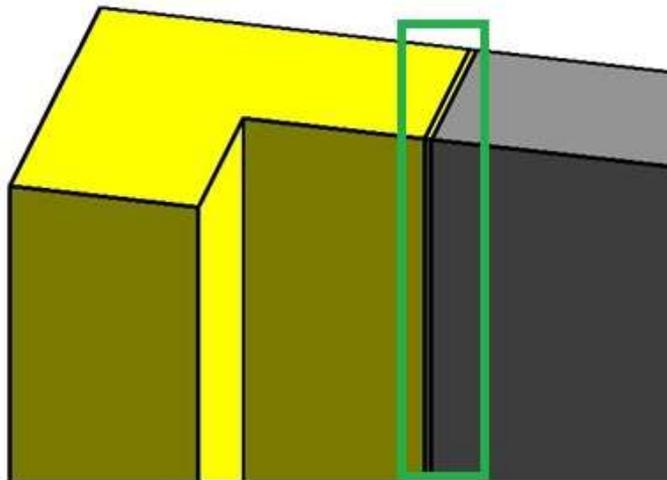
Acercamiento de columna y muro en la que se observa una interferencia
